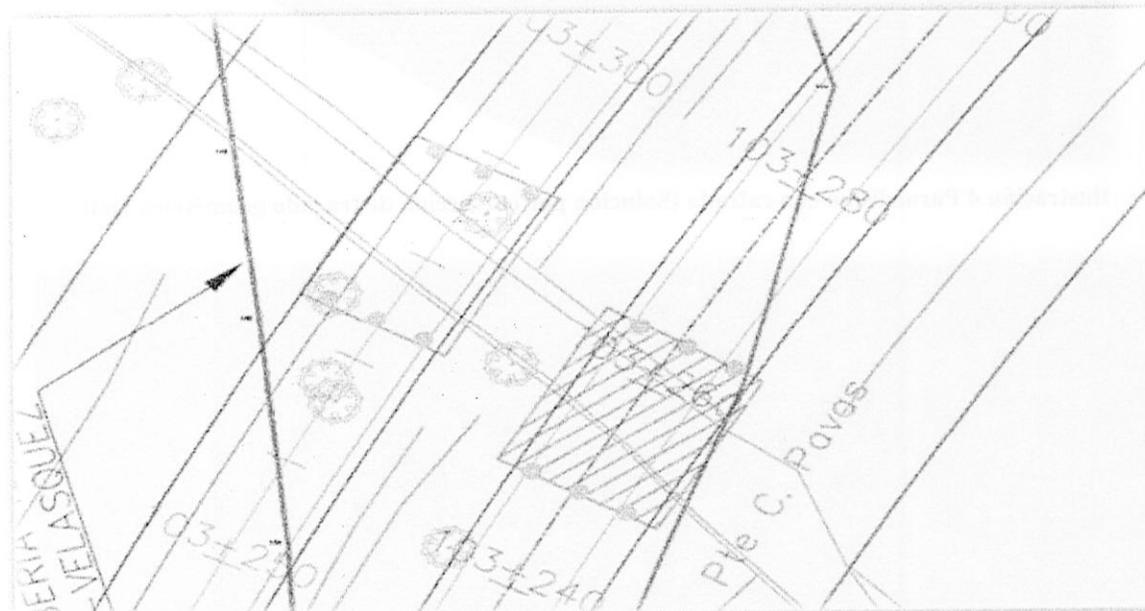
Acercamientos críticos con estructuras viales (Puentes) e infraestructura petrolera
